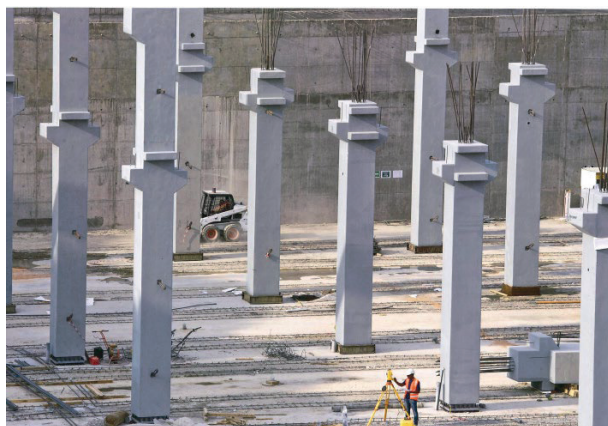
Poteaux préfabriqués du Métro de Ryad
